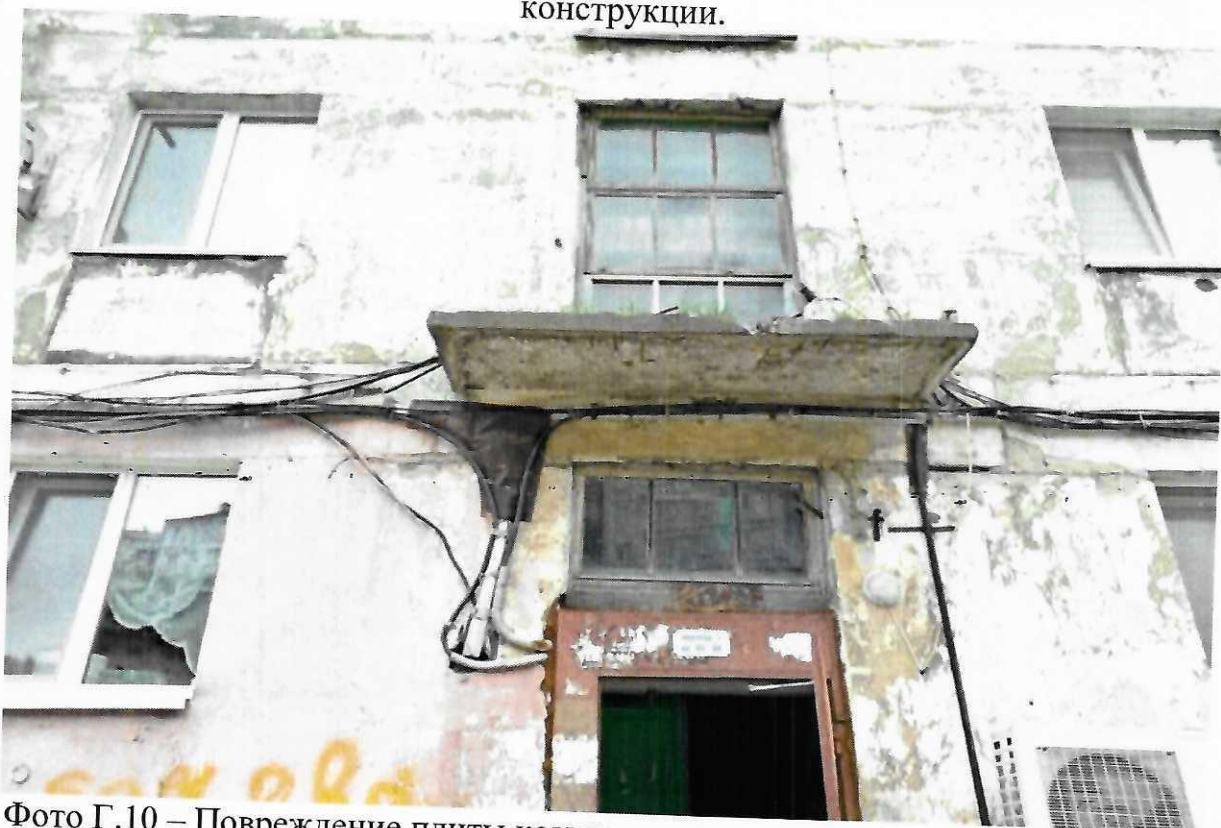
Повреждение плиты козырька: следы увлажнения и промерзания на нижней части плиты, гидроизоляция повреждена, ржавые пятна, следы протечек, трещины шириной до 2 мм. Наличие растительности.
